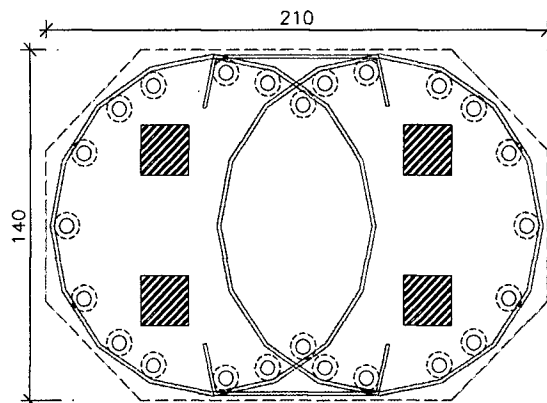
Proyección en planta de ubicación de ductos de acero en columna.
